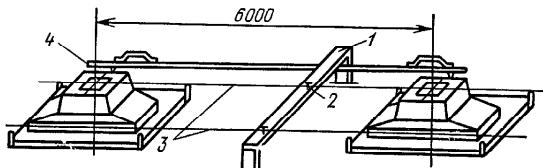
Установка фундаментов под колонны по причалкам и шаблону:
